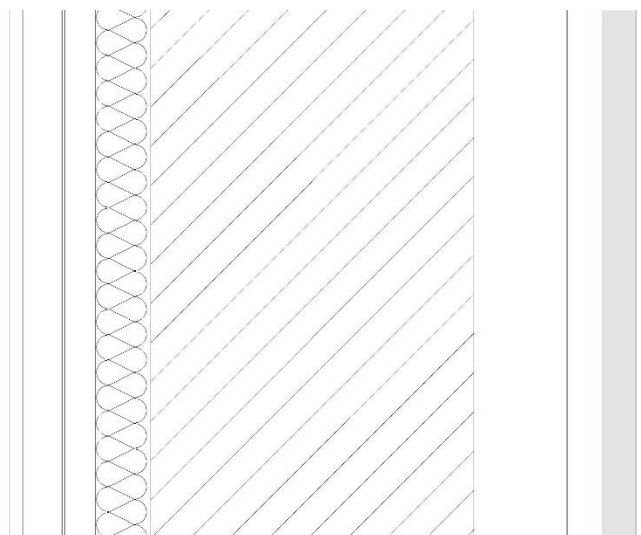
Corte esquemático da parede exterior (interior do lado direito).
